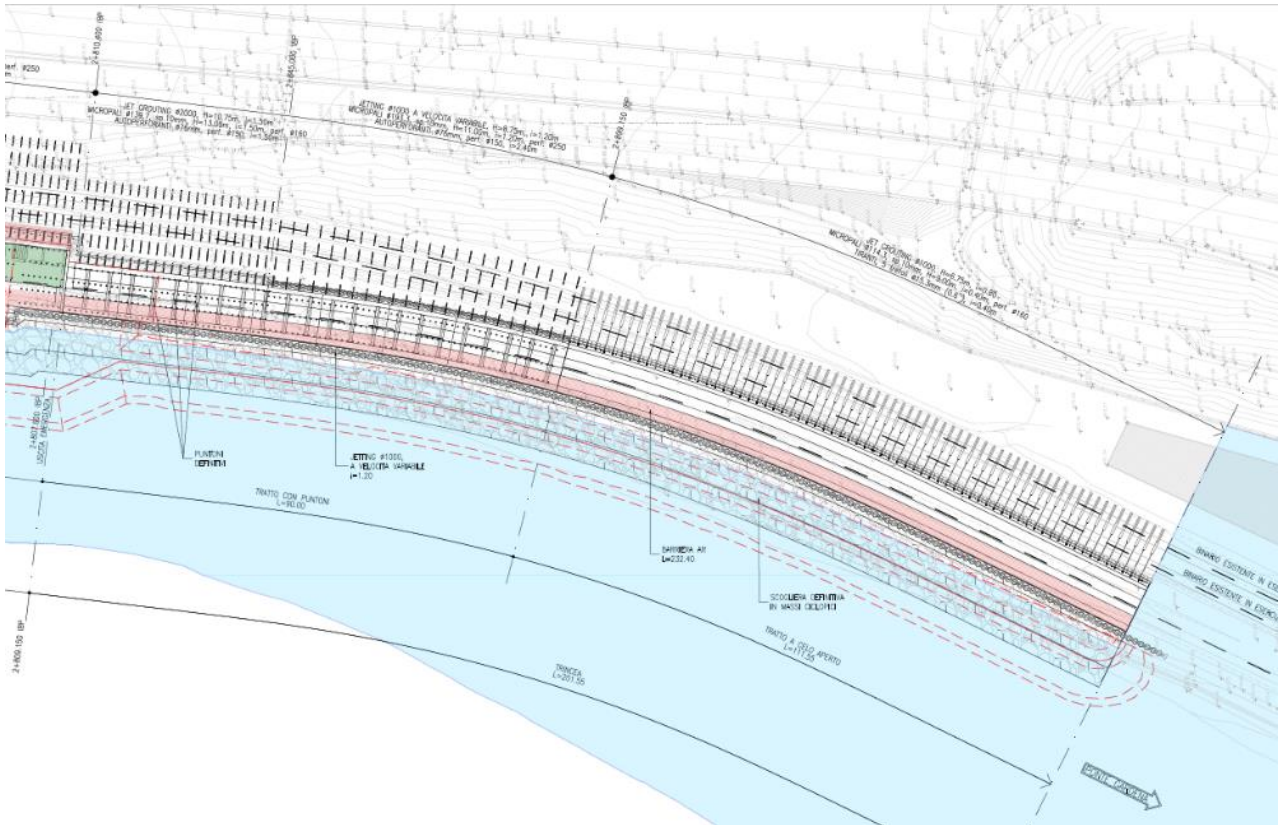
Progetto Esecutivo - Planimetria dell'imbocco (Parte 1/2)
